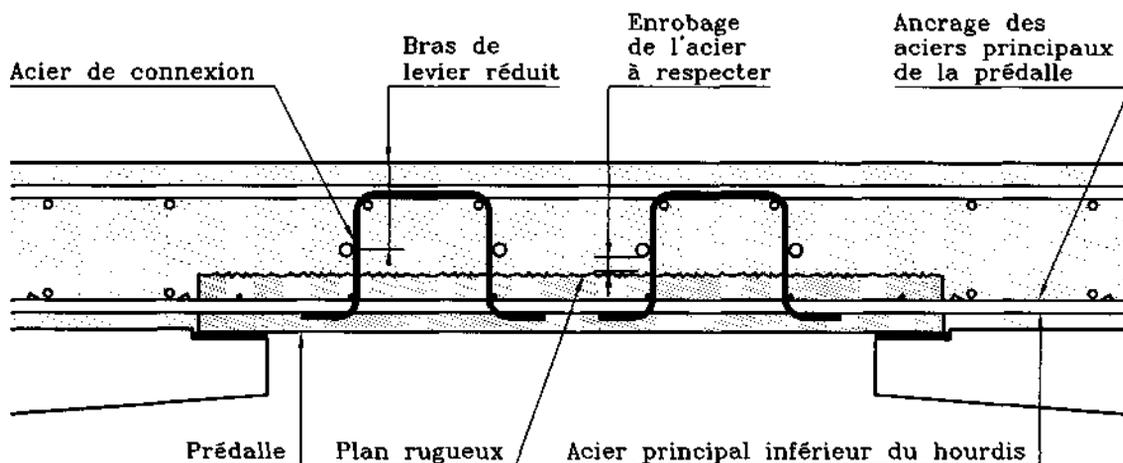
Principe de ferrailage du hourdis sur prédalle participante
